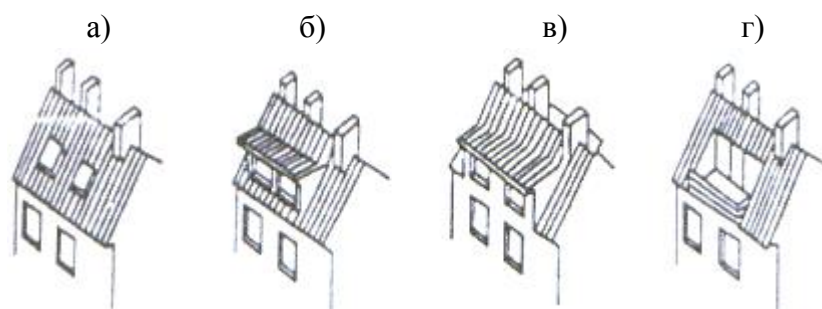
Размещение оконных проемов в зданиях с мансардными этажами и устройством балконами:
